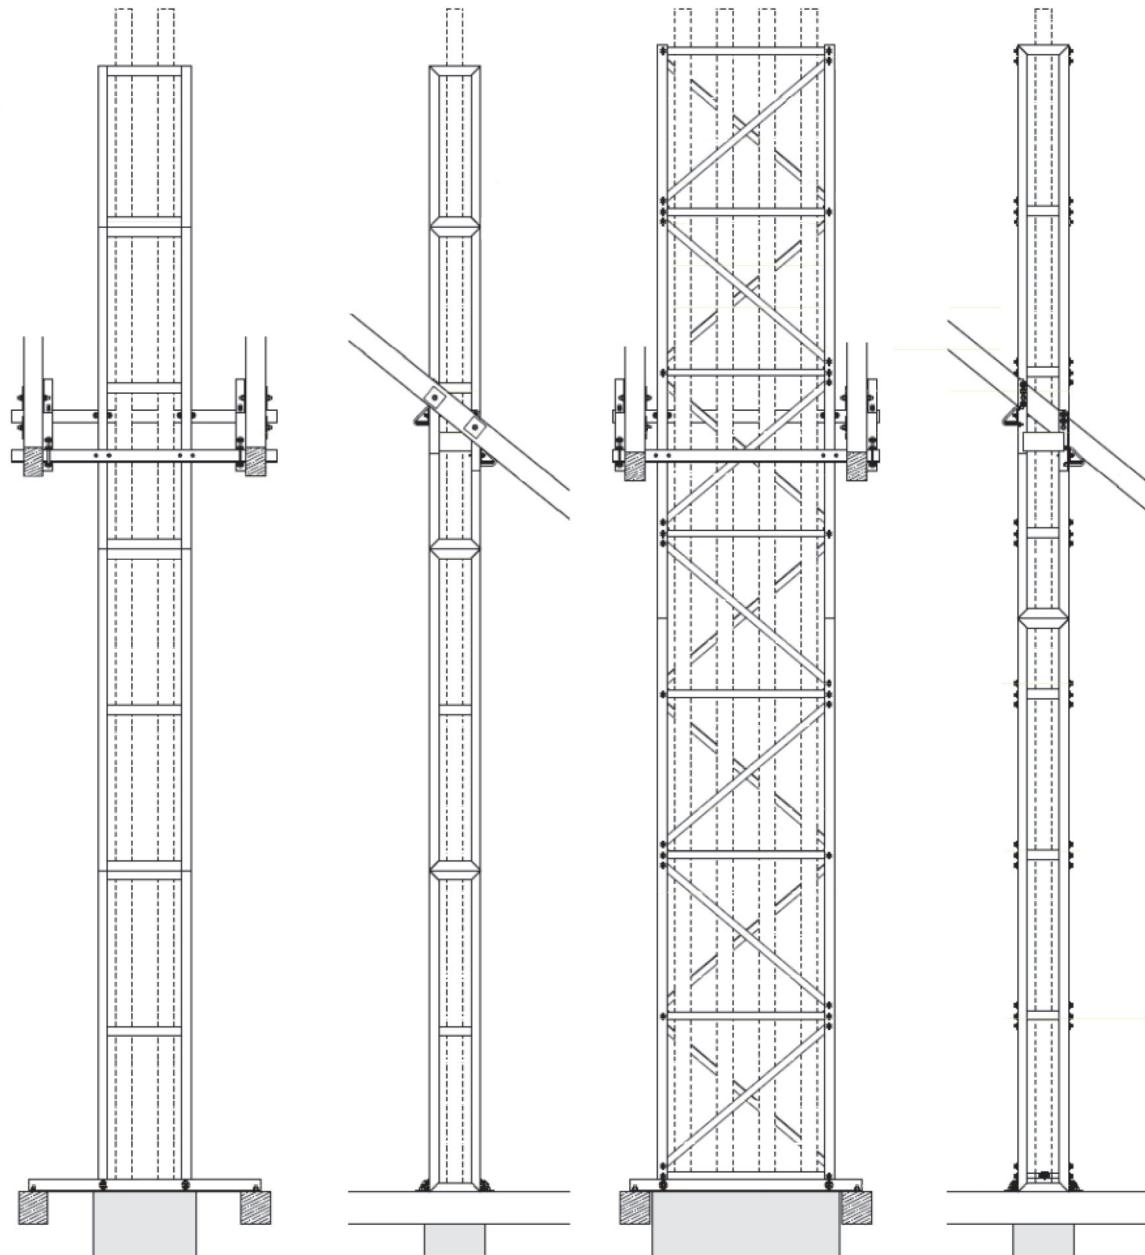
Detalji pridržanja čeličnih TD za krovnu i podnu konstrukciju
